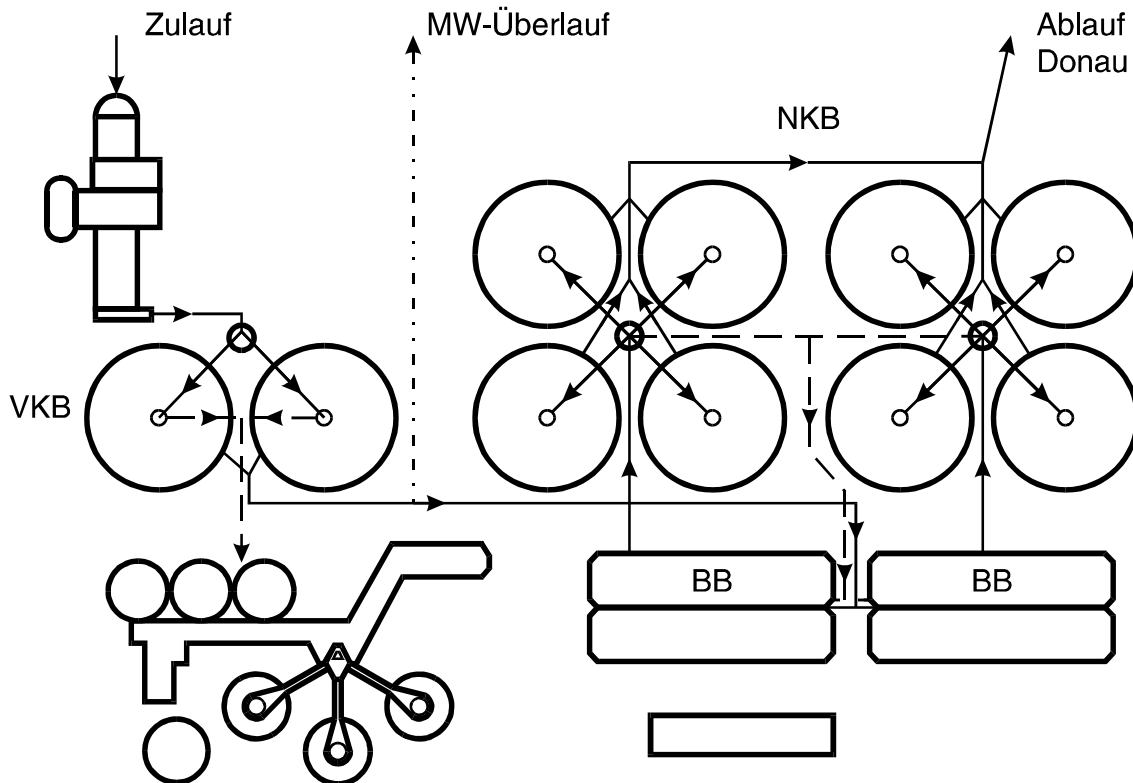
Lageplan der RKL-Asten nach Inbetriebnahme 1982.
